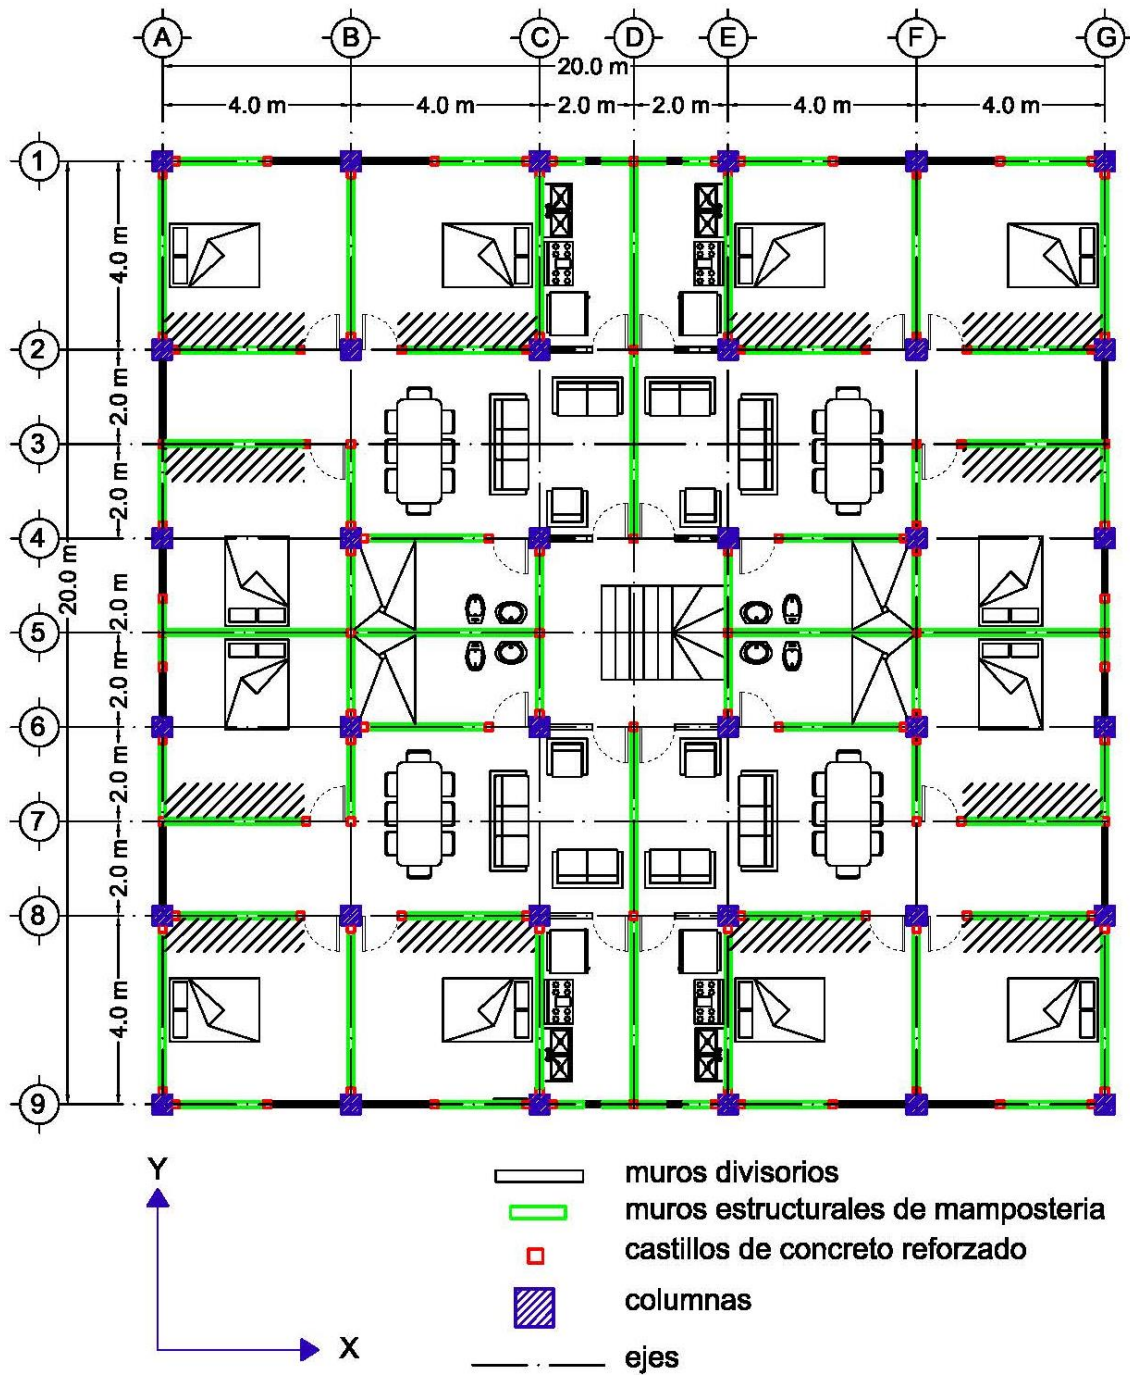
Planta arquitectónica de los niveles superiores, modelo M2.
